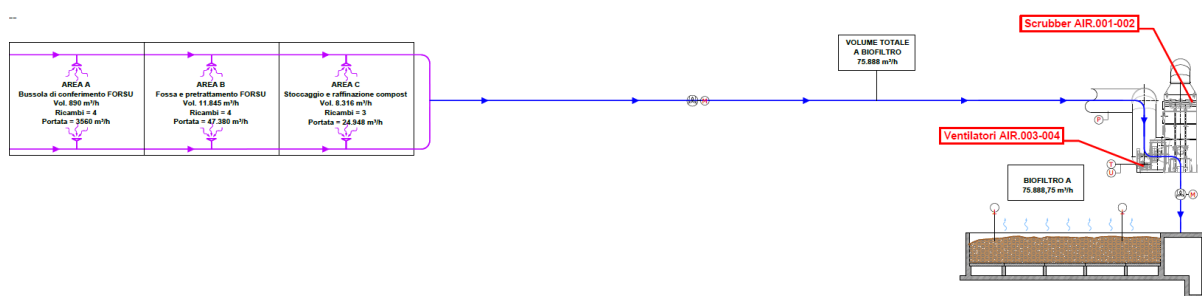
Schema aria biofiltro 2 – Stralcio Allegato n. 8 – Schema rete aria
